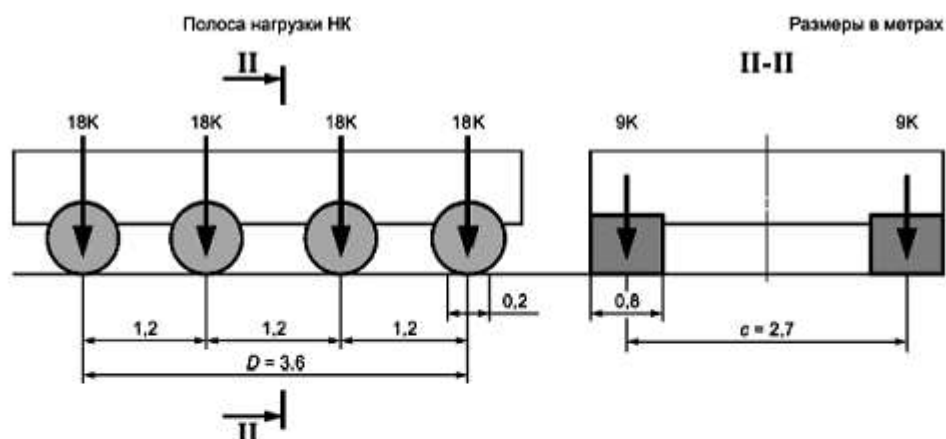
Схема нормативной нагрузки для расчета дорожной одежды, земляного полотна, подпорных стен и мостовых сооружений
